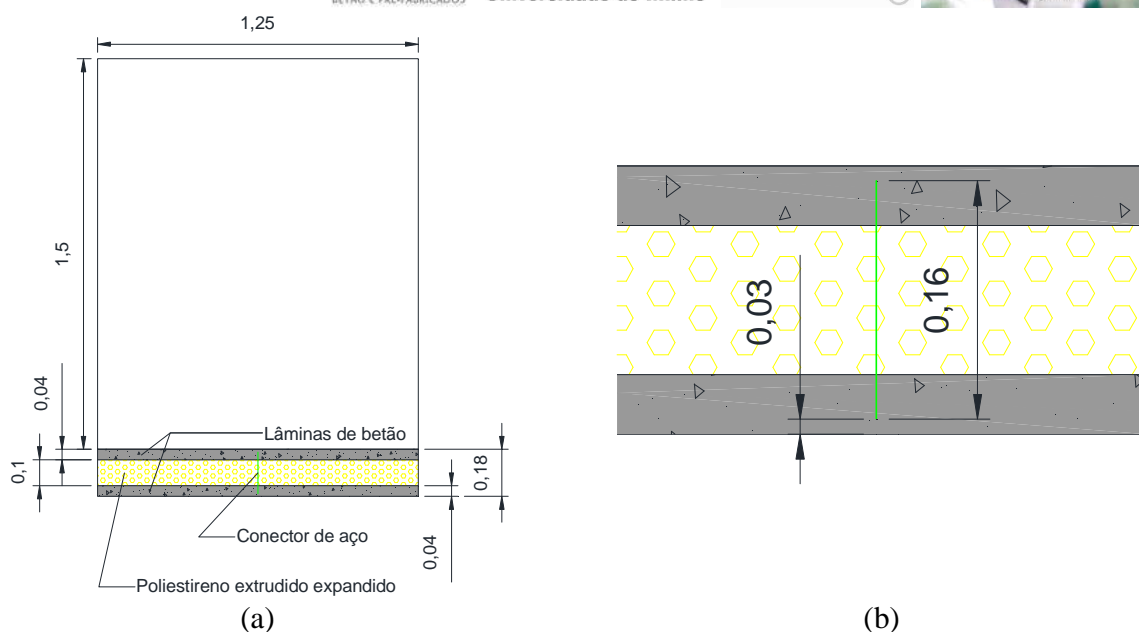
Geometria do painel sandwich com conectores de treliça de aço (vista em planta e pormenor; unidades em metros).
